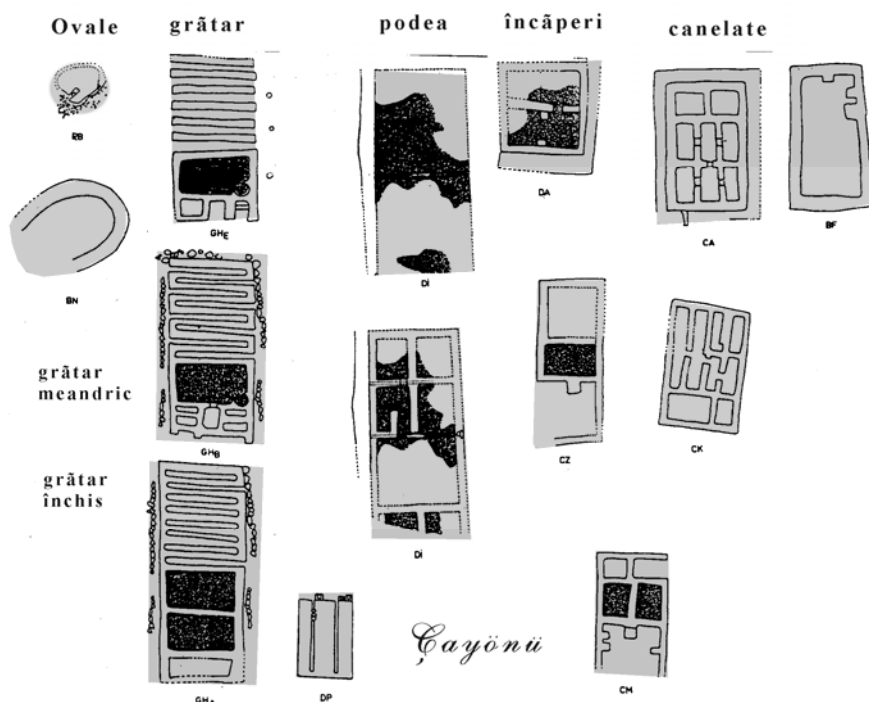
Çayönü Tepesi, tipuri de plan de construcții, după M. Özdoğan
